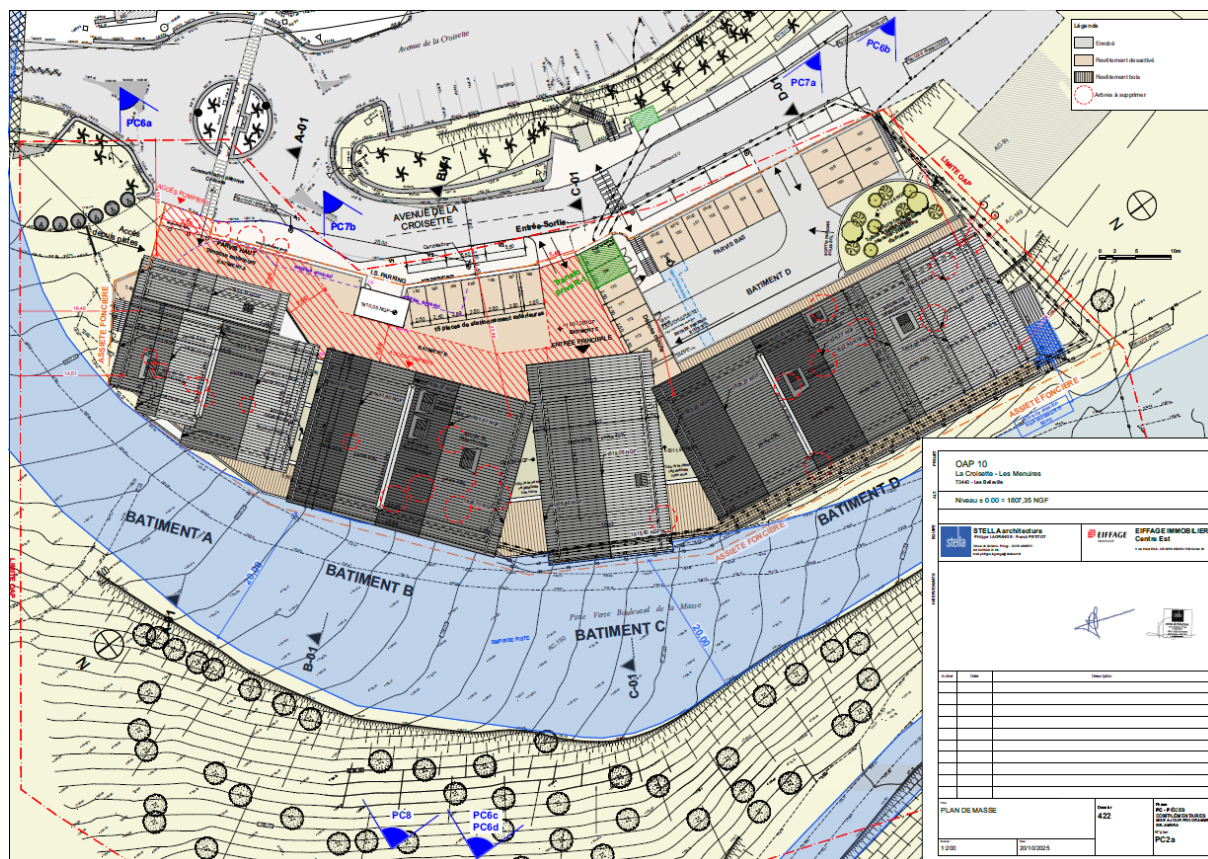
Plan de masse général du projet (source : Eiffage Construction)
